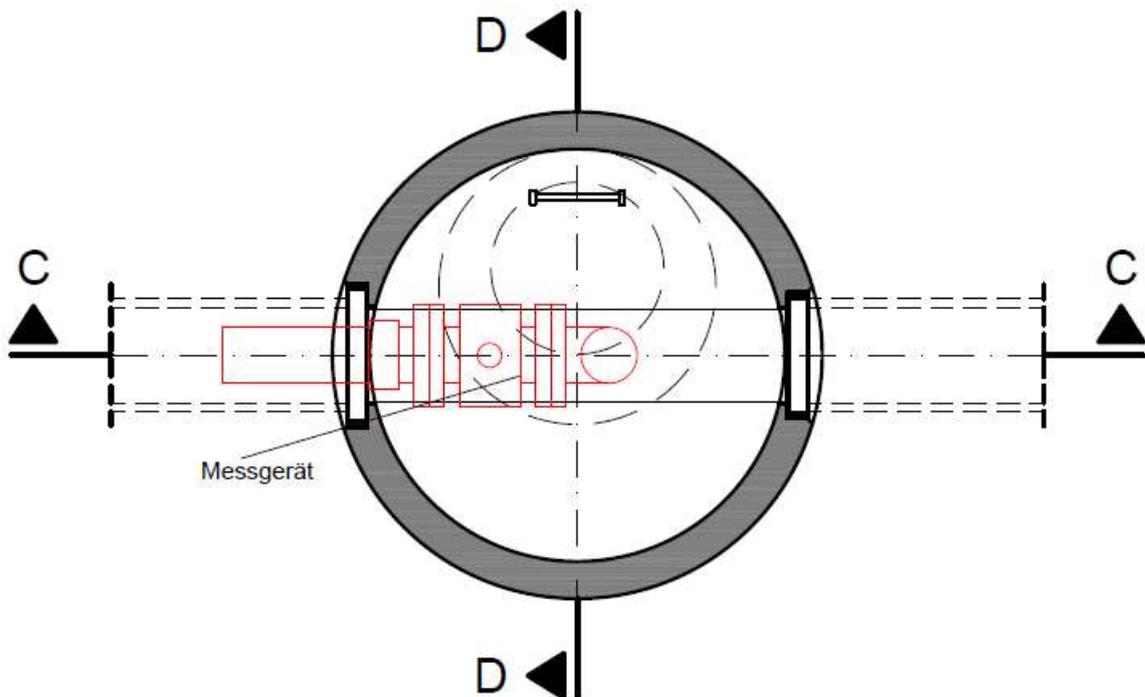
Regelzeichnung Prüfschacht, Grundriss
